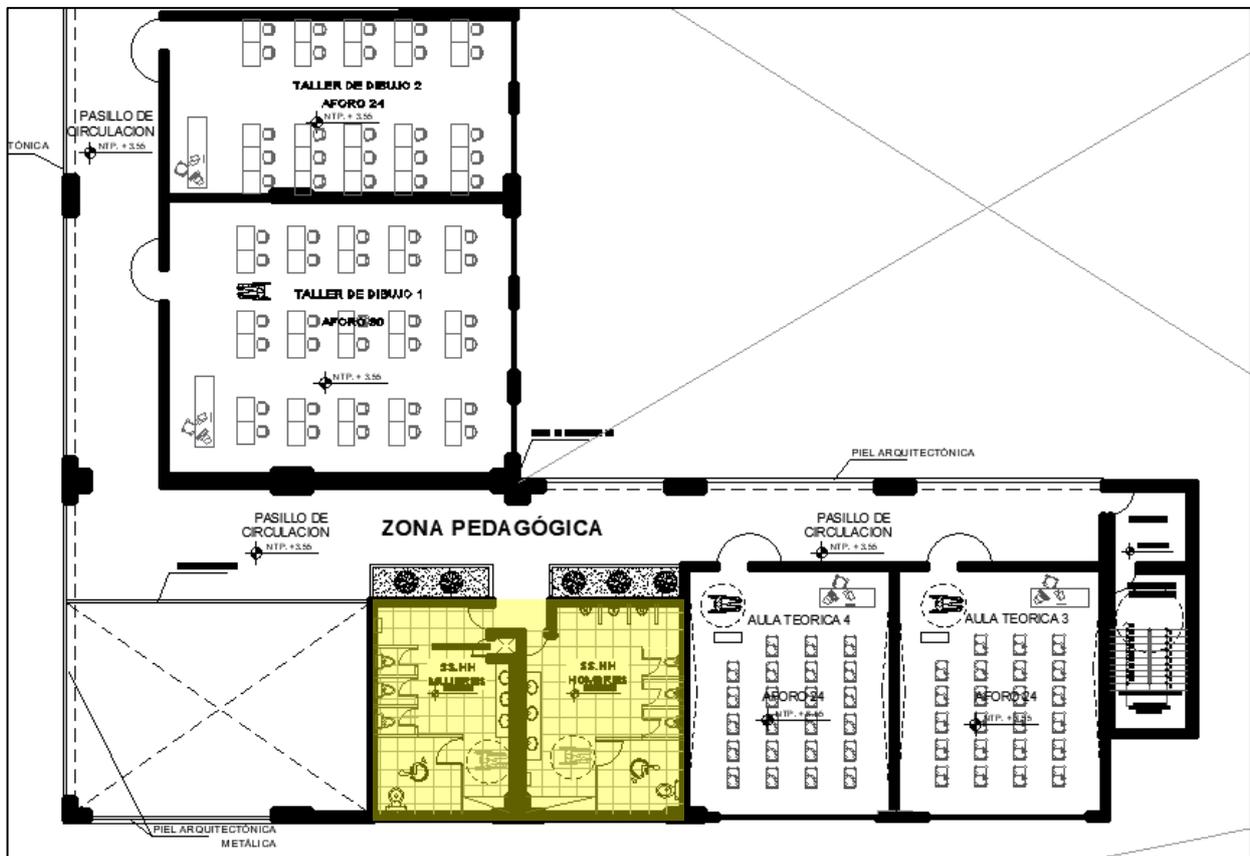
Planta segundo nivel del proyecto-zona educativa. FUENTE: Elaboración propia.
